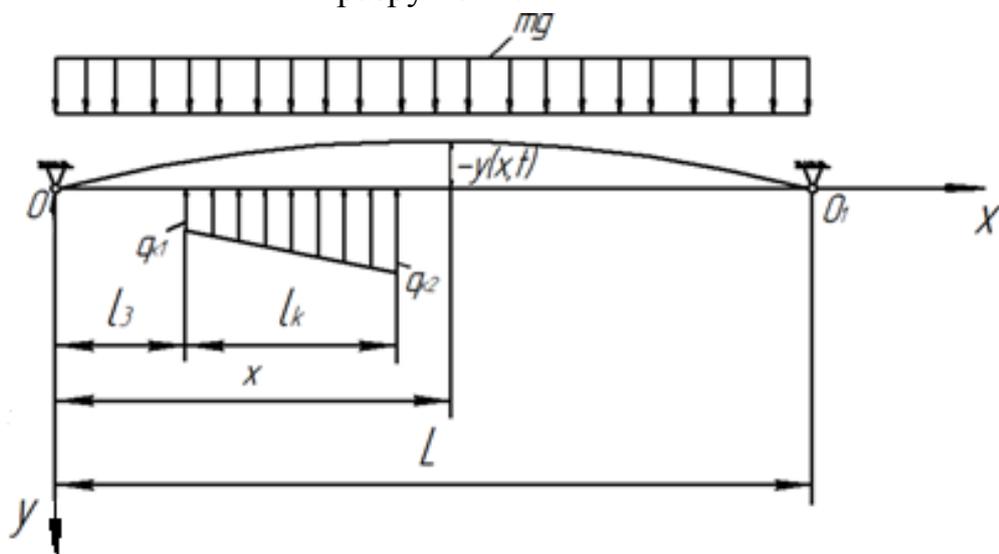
Расчётная схема блока кровли после хрупкого разрушения
